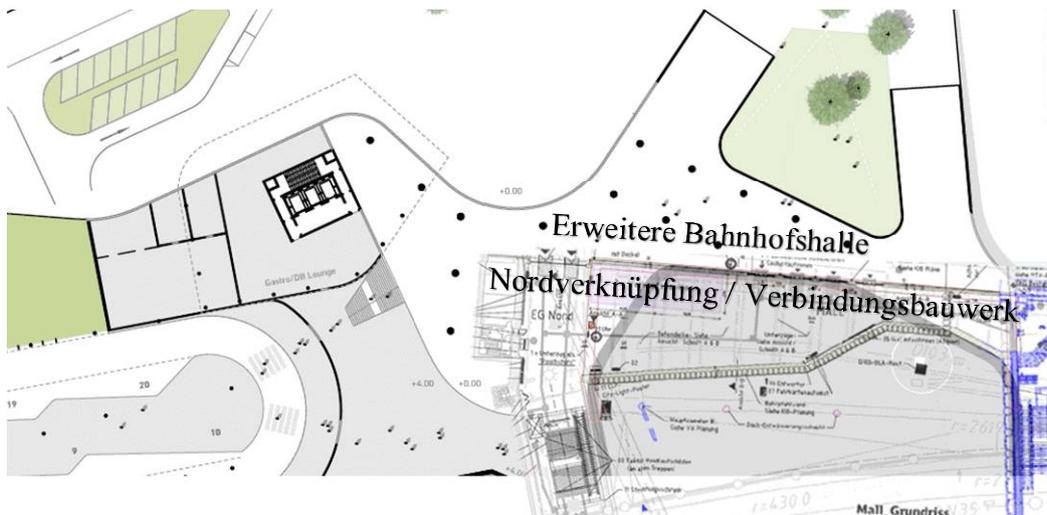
Überlagerung geplante erweiterte Bahnhofshalle mit bislang geplantem Verbindungsbauwerk
